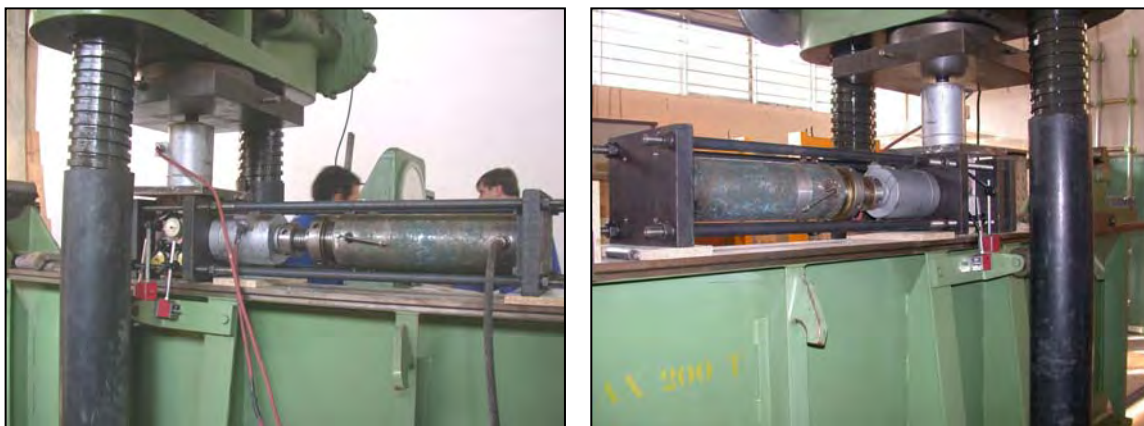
Vistas del dispositivo de ensayo de tripletas
